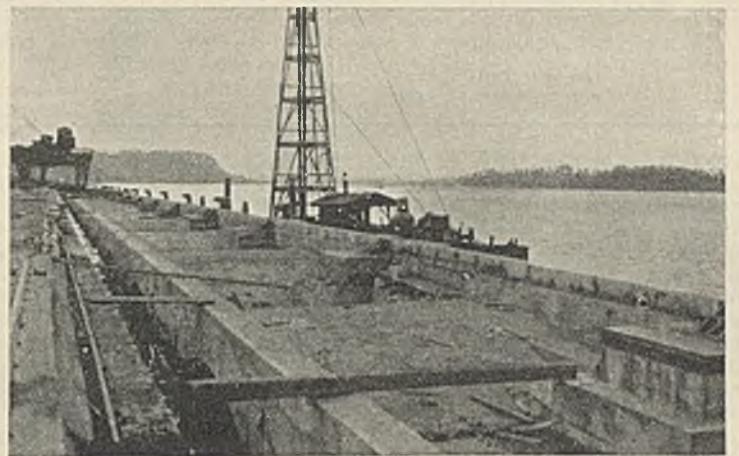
Die fertig betonierte Mauer vor der Sandaufschüttung.
